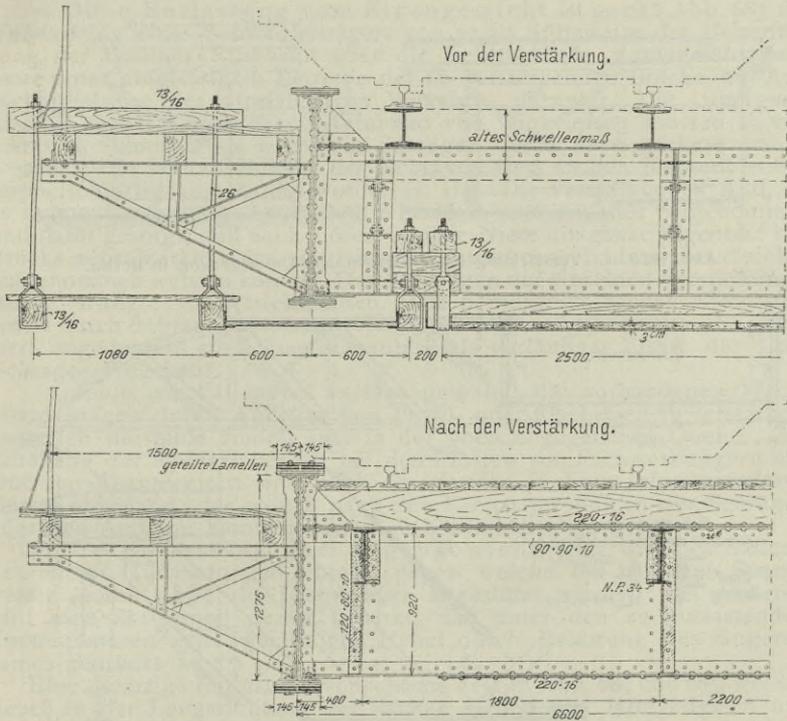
u. 681. Verstärkung einer zweigleisigen Unterführung der Berlin-Lehrter-Bahn ohne Unterfangung. Nach Labes, Verstärkung eiserner Brücken.
